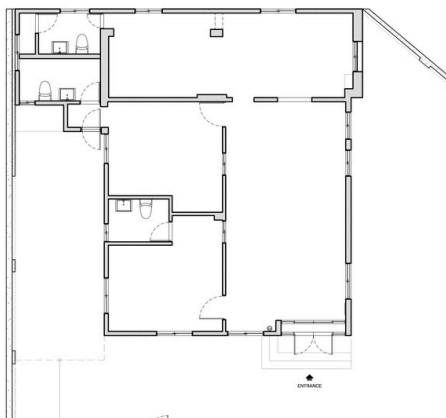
Southern Sunshine House, Planta Base<sup>8</sup>
